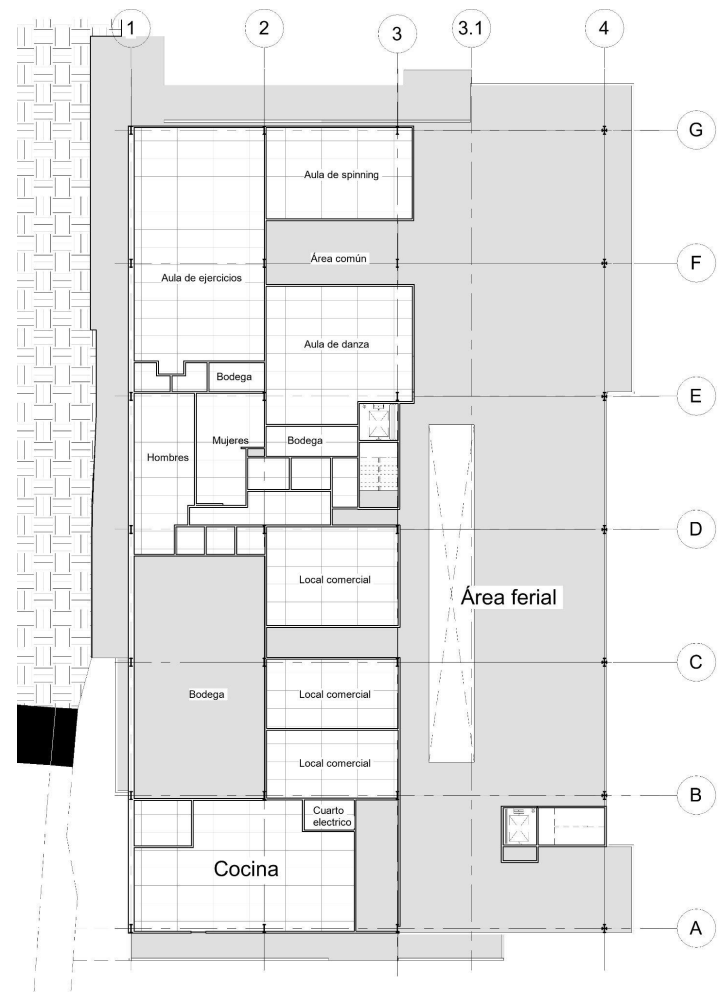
Planta de cielo del primer nivel. Fuente propia.
